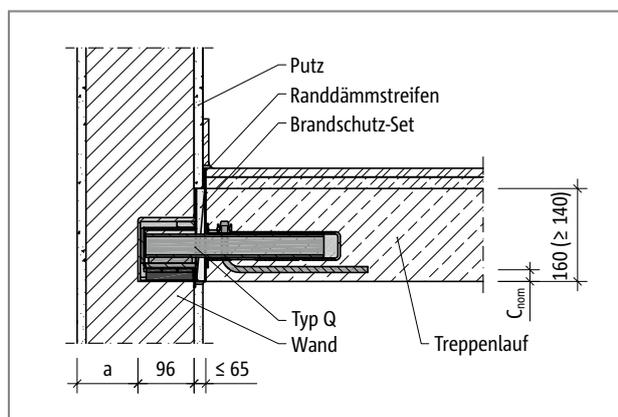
Schöck Tronsole® Typ Q: Brandschutzausführung
